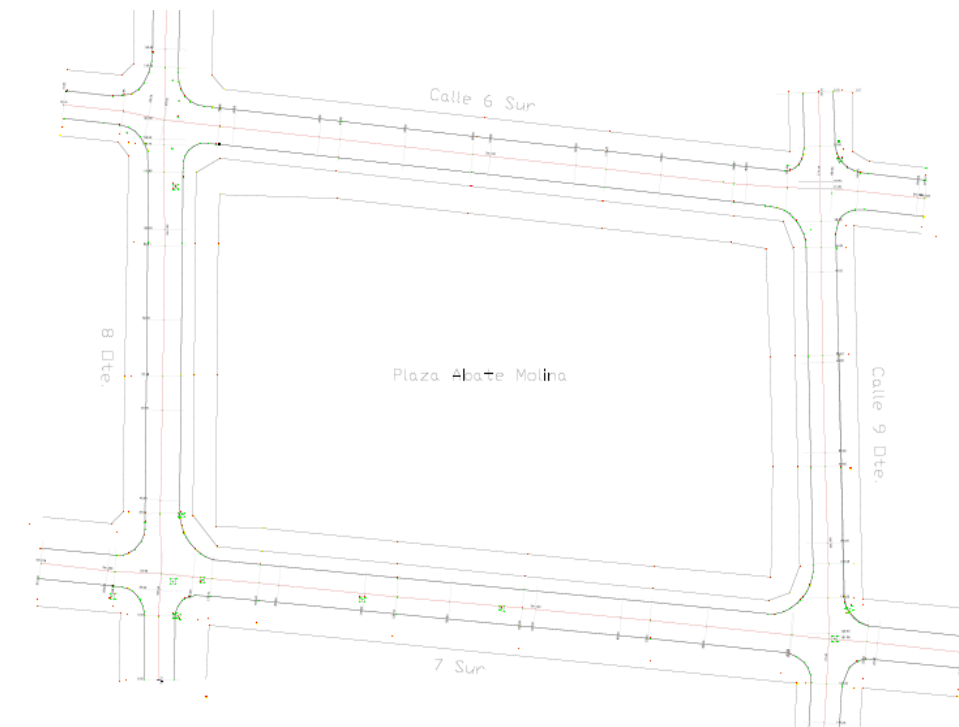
Vista en planta Levantamiento Topográfico completo
